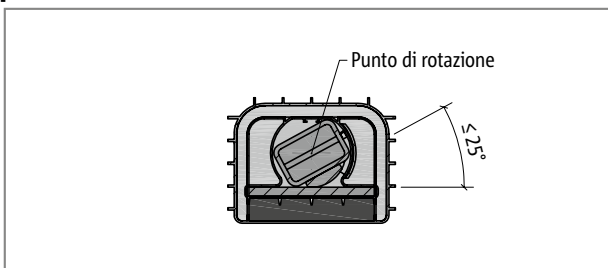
Schöck Tronsole® tipo Q, variante di montaggio inclinata dell'elemento portante
